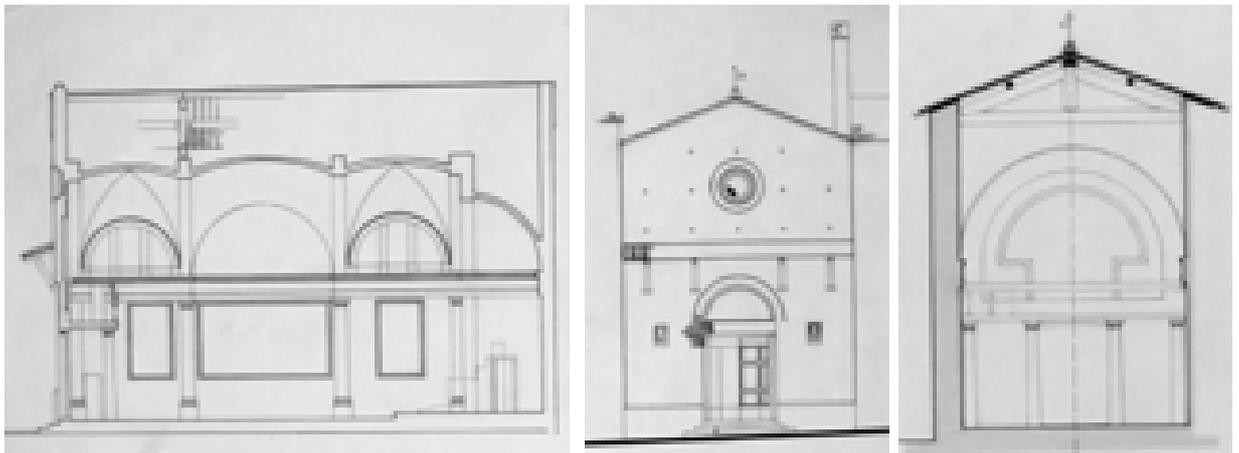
SX, San Leonardo stato attuale sezione e prospetto– s.d. (AABS-94.0139)
